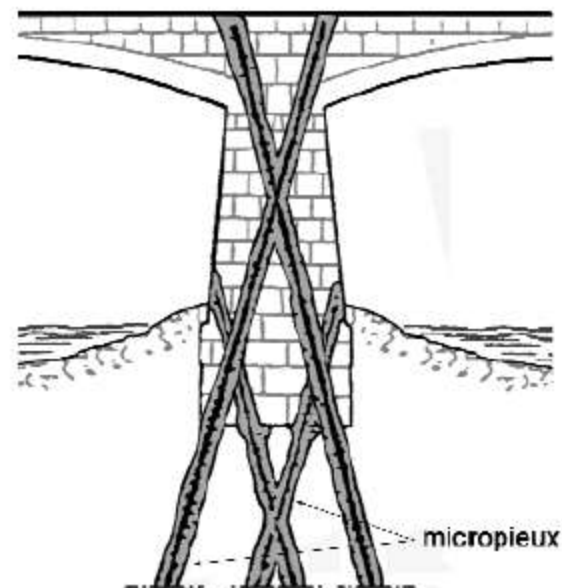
reprise en sous-œuvre d'une pile de pont en maçonnerie
